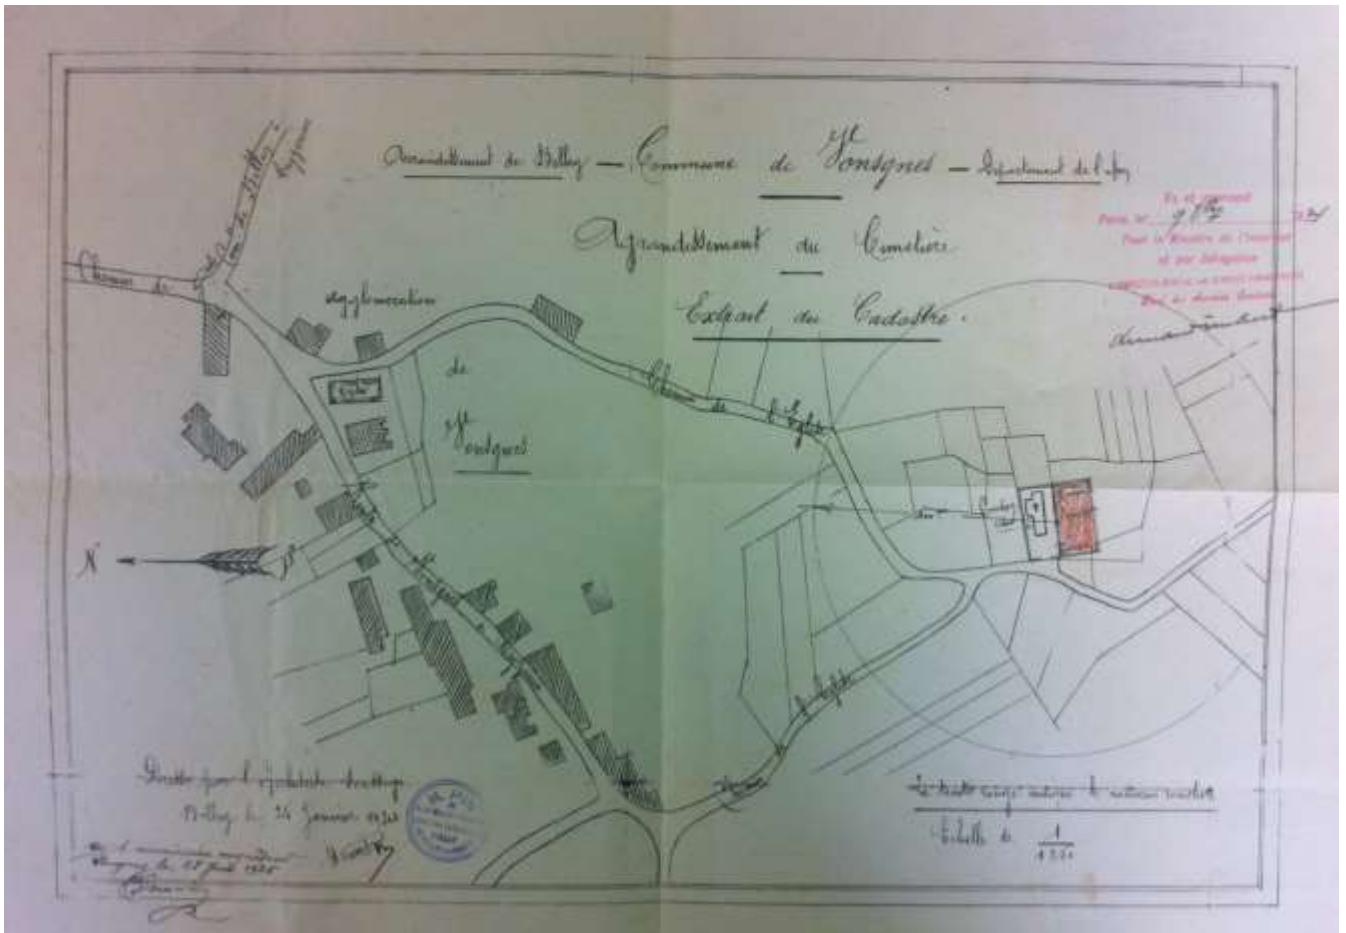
Plan du nouveau cimetière, 1924 (M2)
